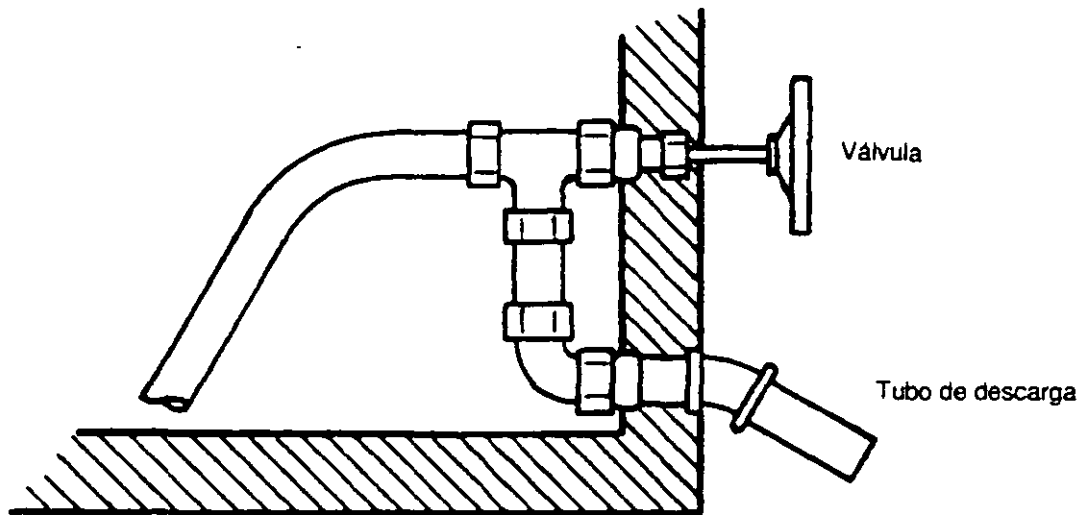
Dispositivo Usado en Tanques de Camión o de Almacenamiento para Muestrear Asfalto.
